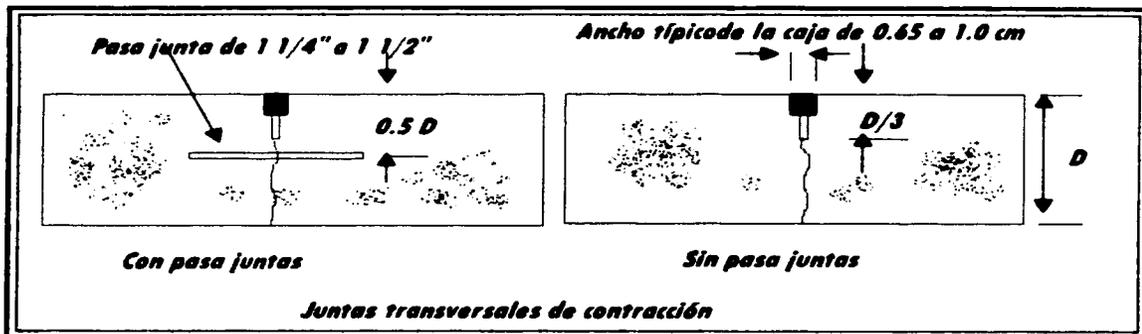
Construcción de juntas transversales y cajas para sellado.
